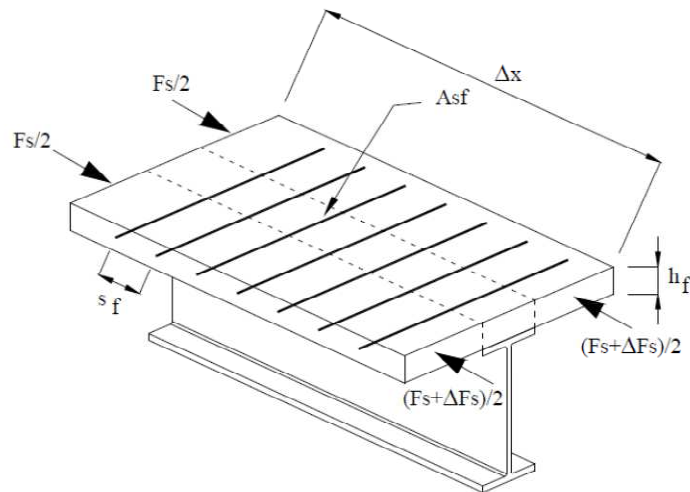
Distribuzione della sollecitazione di taglio longitudinale nella piastrina in calcestruzzo.
